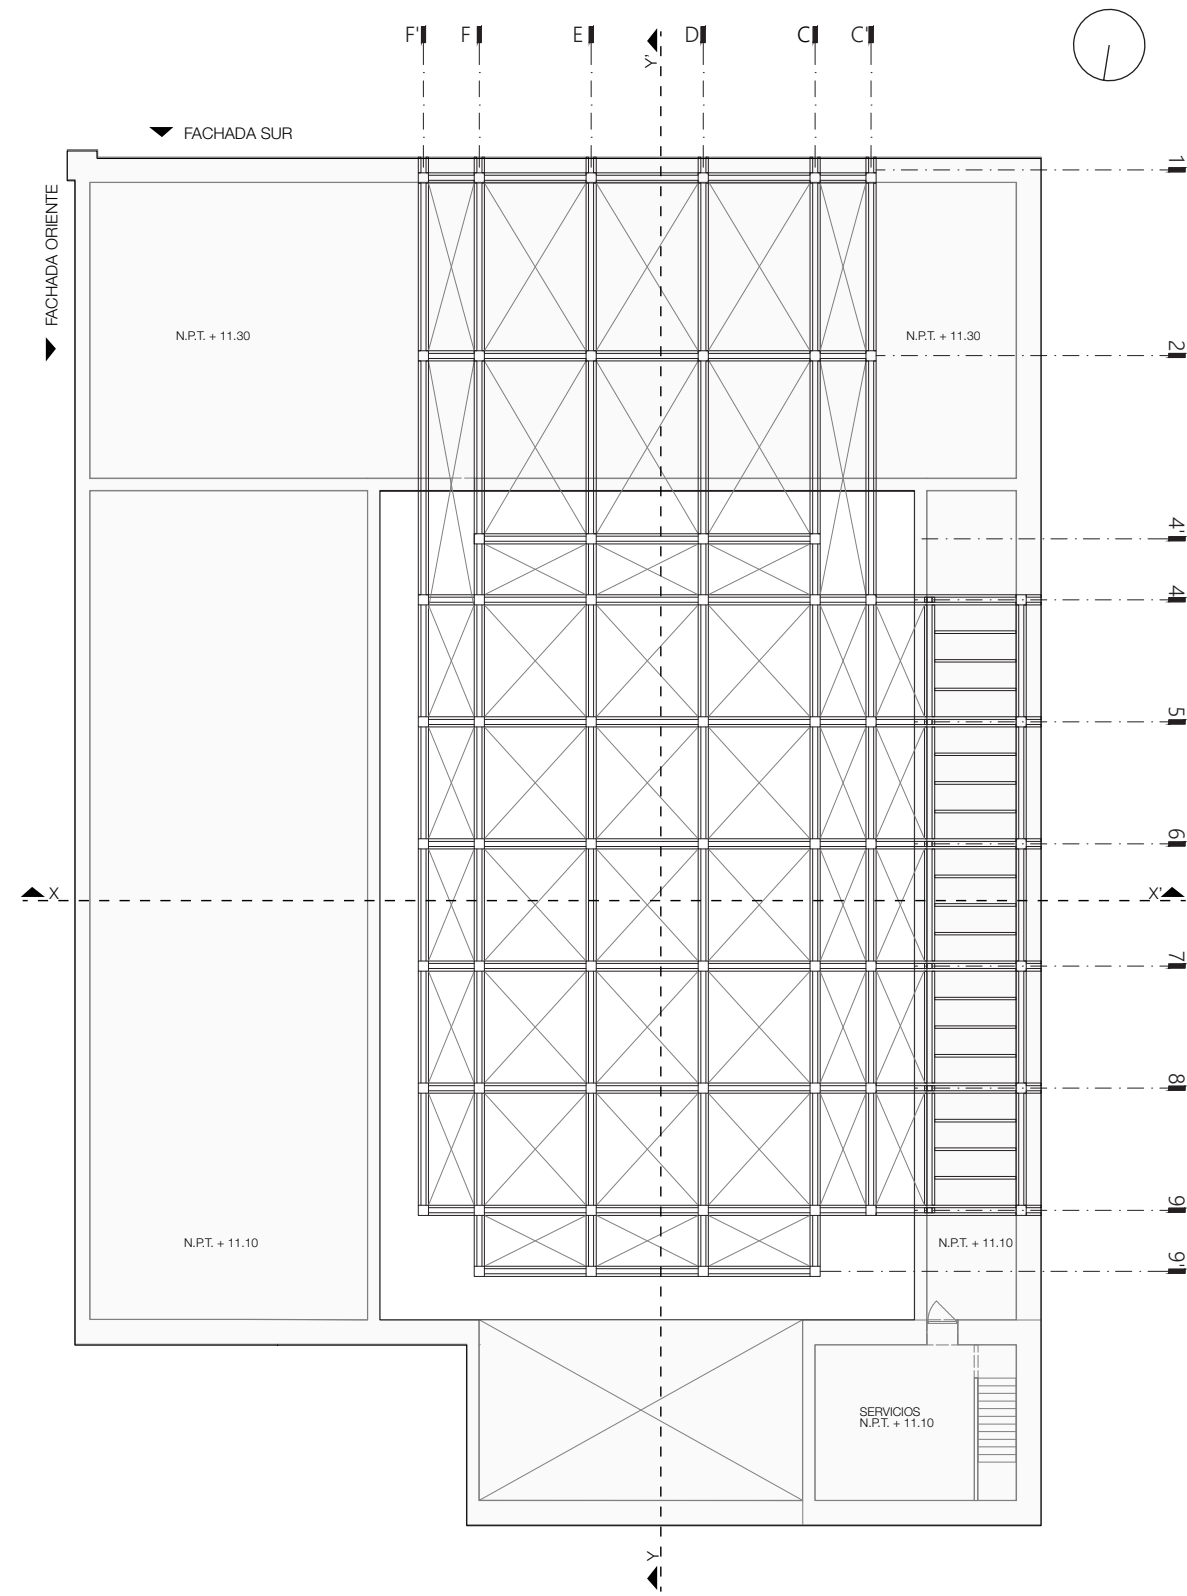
Planta arquitectónica nivel +16.30m. Fuente: Elaboración propia.
